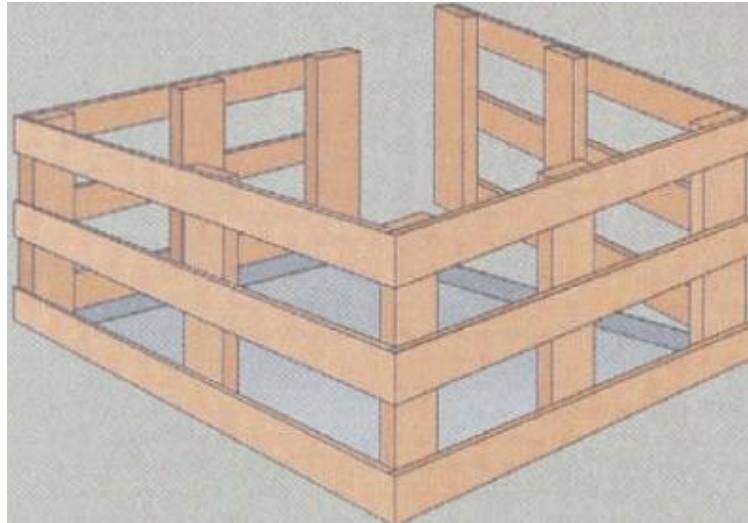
Guarda-corpos para proteção de abertura em paredes.
